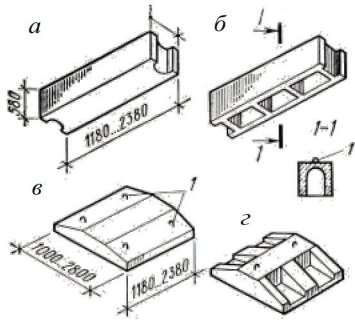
Елементи збірних бетонних і залізобетонних фундаментів:
